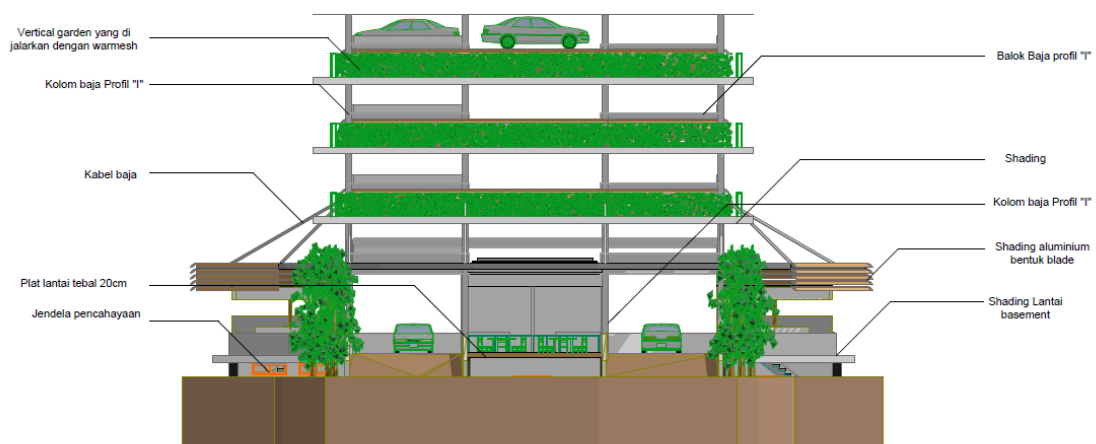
lantai 1 sampai 8 (sumber: analisa penulis)
